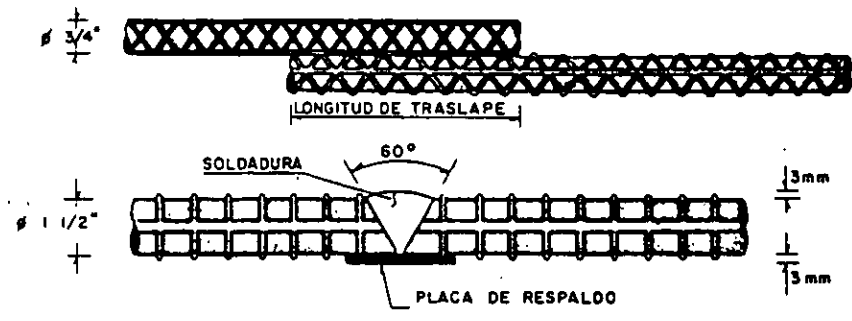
Detalle de traslape y soldadura de varillas
